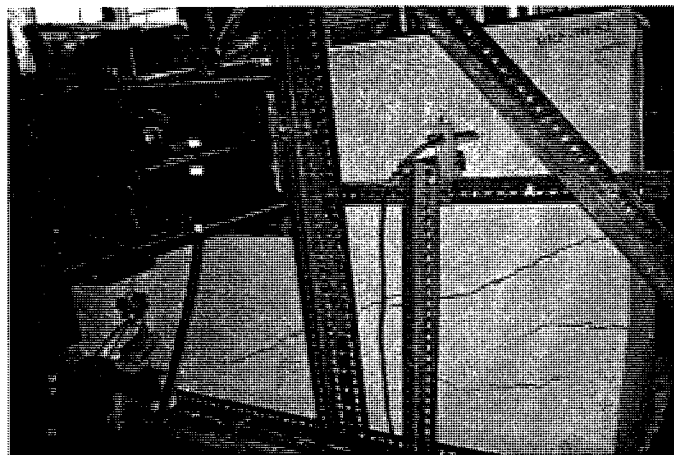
301: Fissuration face avant après les essais d'impacts du parapet en BRF 70MPa-1.5%
